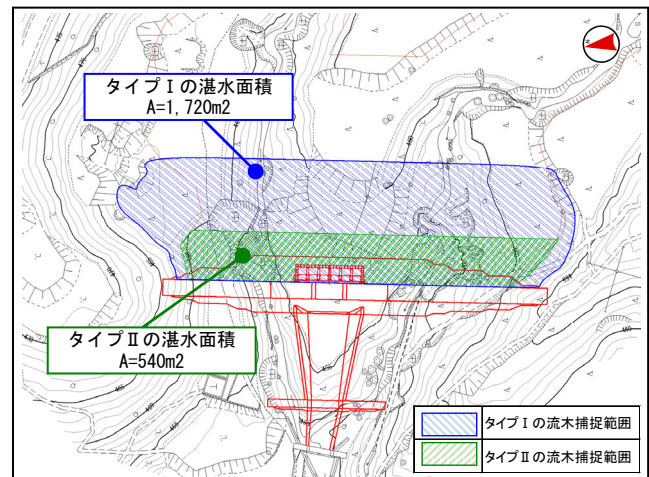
流木捕捉工のタイプごとの捕捉範囲（平面図）
